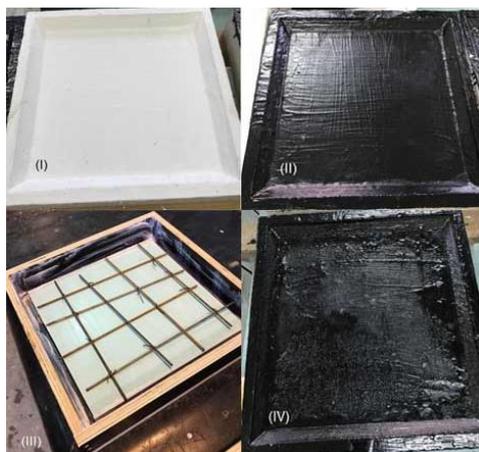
(I) Laje impermeabilizada com membrana acrílica (II) Laje impermeabilizada com membrana asfáltica (III) Molde com armadura de aço (IV) Laje impermeabilizada com emulsão asfáltica
